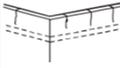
Fissuras horizontais causadas por expansão dos tijolos (Thomaz, 1989).
